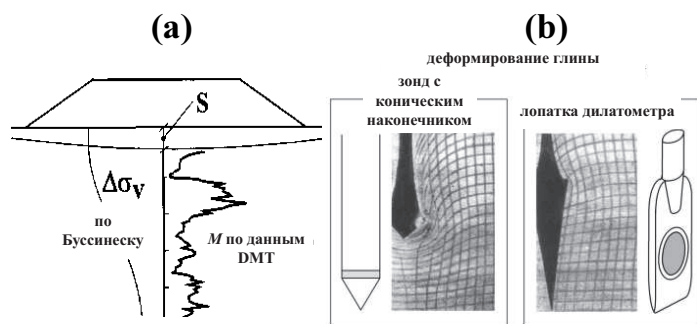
а – Прогноз осадок S по данным испытаний DMT; б – схемы деформирования грунта при внедрении зондов с наконечниками разной формы [2]
